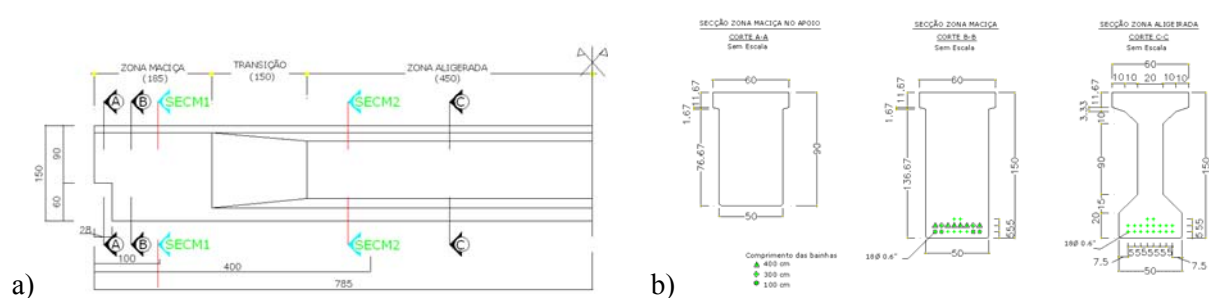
Viga instrumentada: a) alçado e b) secções transversais.
